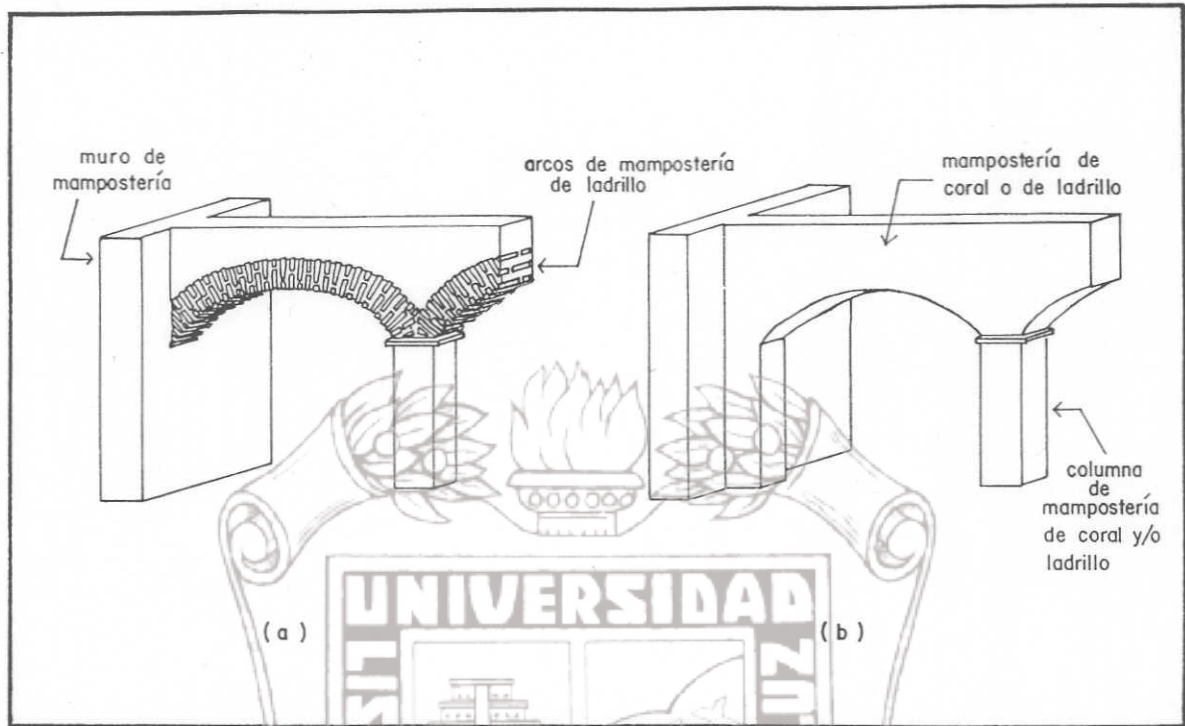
Ejemplos de muro-pilar y pilastras.
